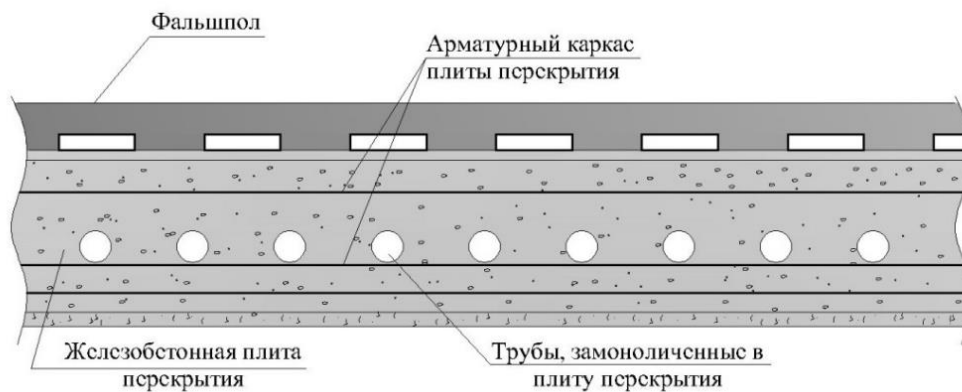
Схема конструкции охлаждаемого перекрытия
